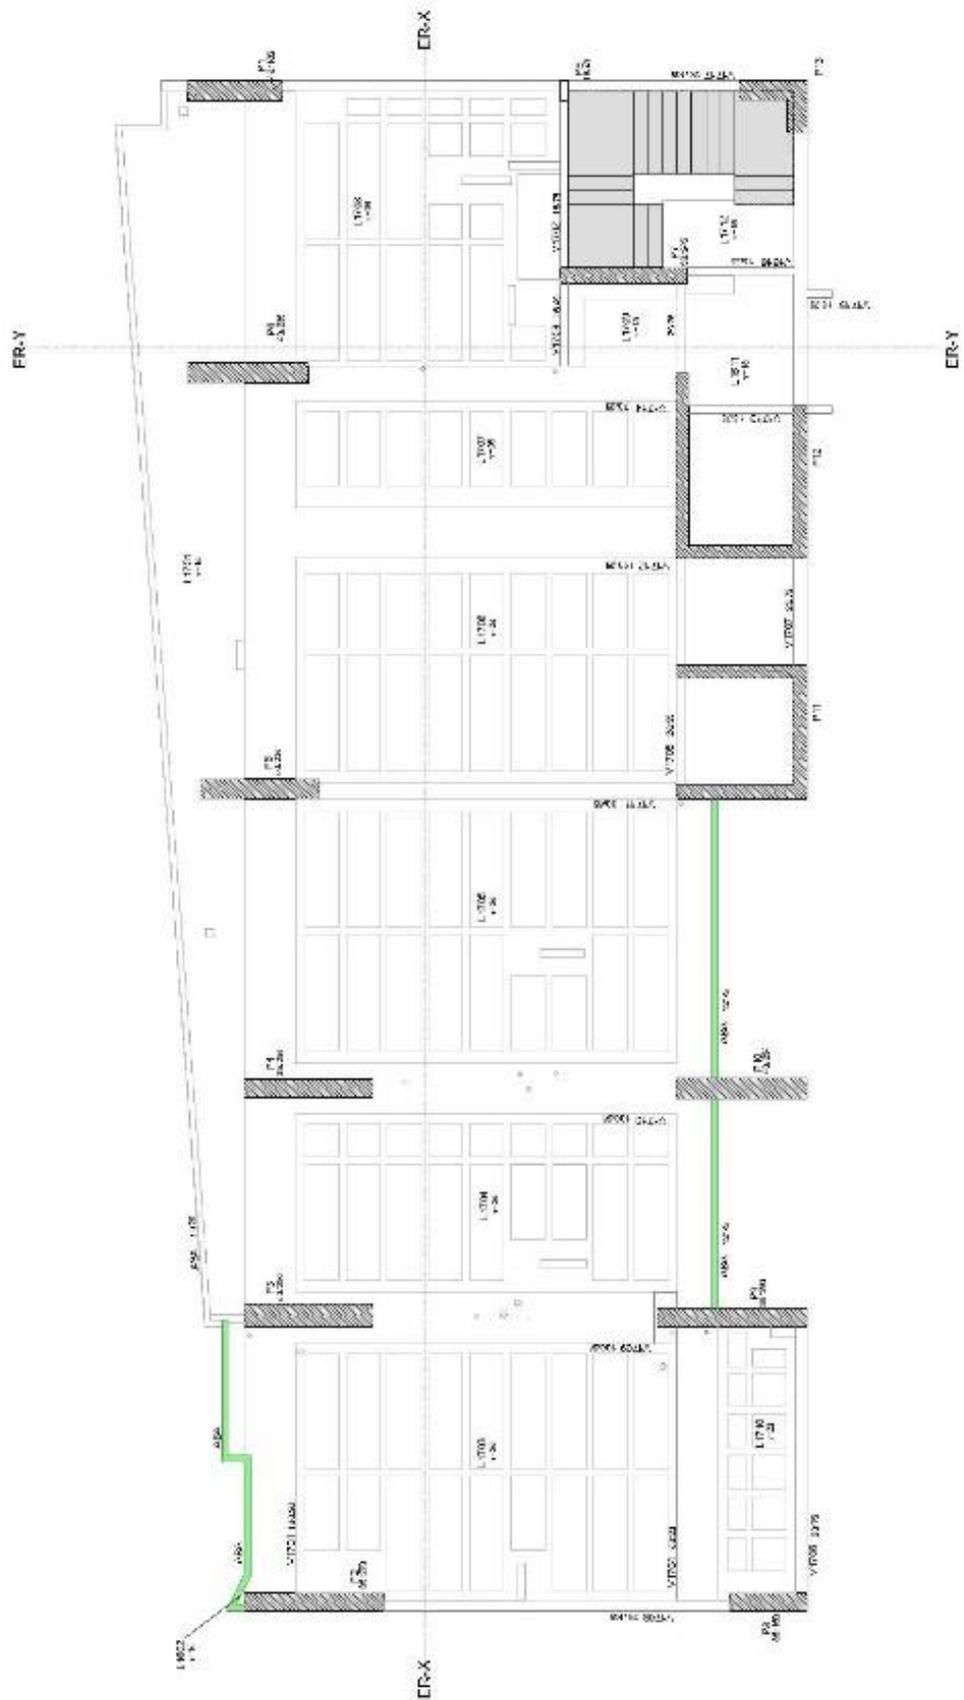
Fôrma 16ª Laje (13º Pavimento) - Fonte: Fornecido pela Construtora
